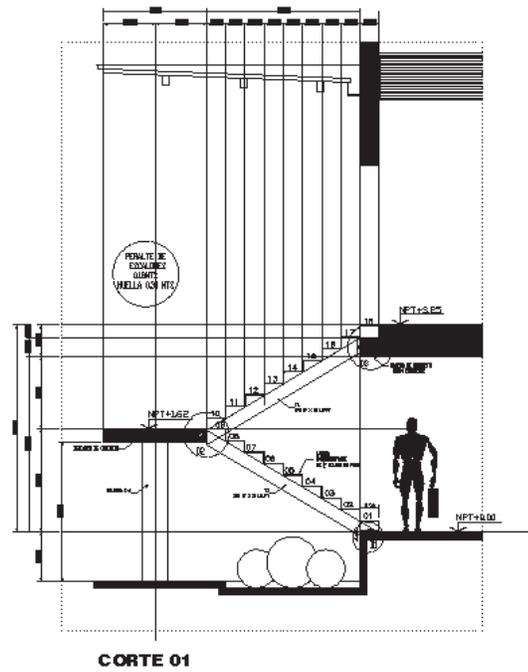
19.- Alzado de nuevo trazo de la escalera.
